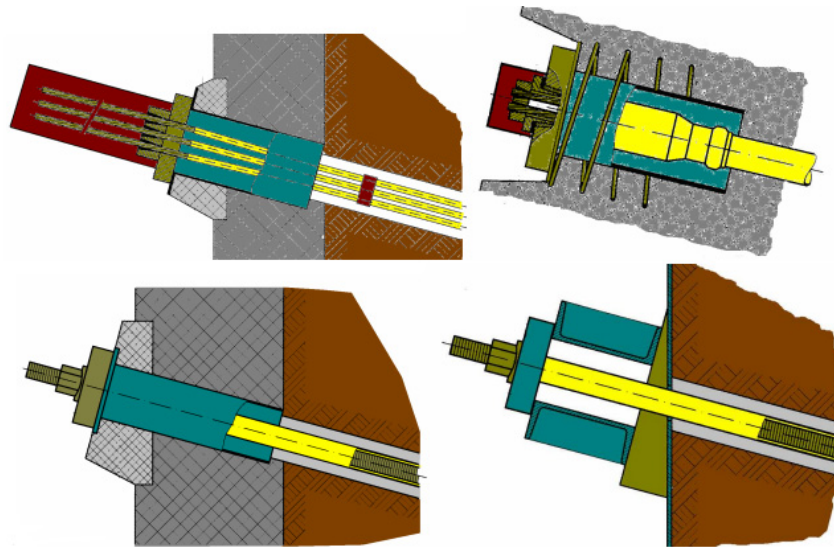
Pormenor da cabeça de ancoragens segundo o tipo de armadura (Carvalho, 2009)
